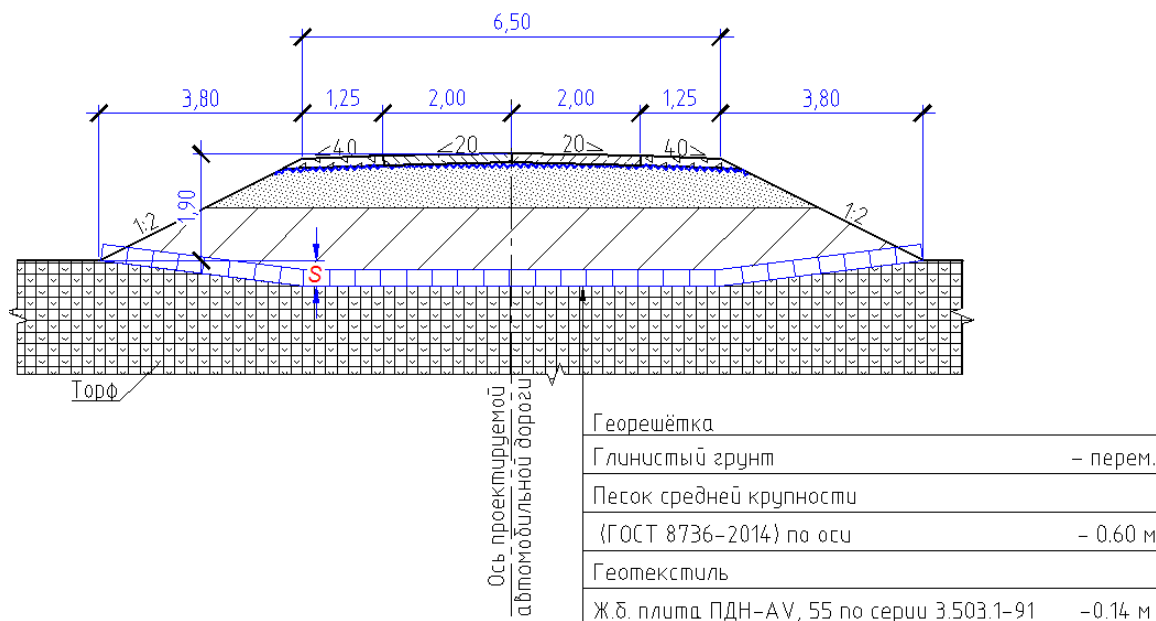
Расчетная схема насыпи, армированной георешеткой
